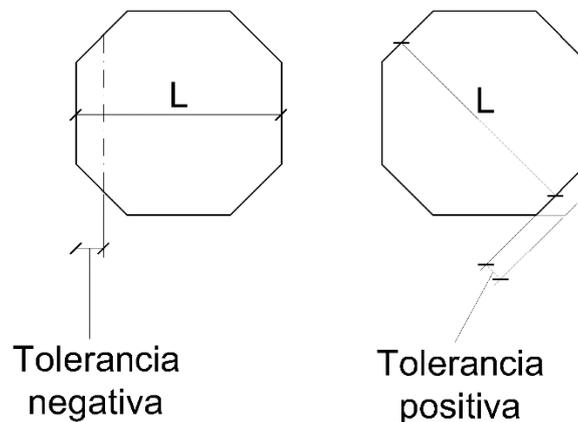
Vista en planta de la desviación permisible en las dimensiones de la sección transversal de fundaciones encofradas.
